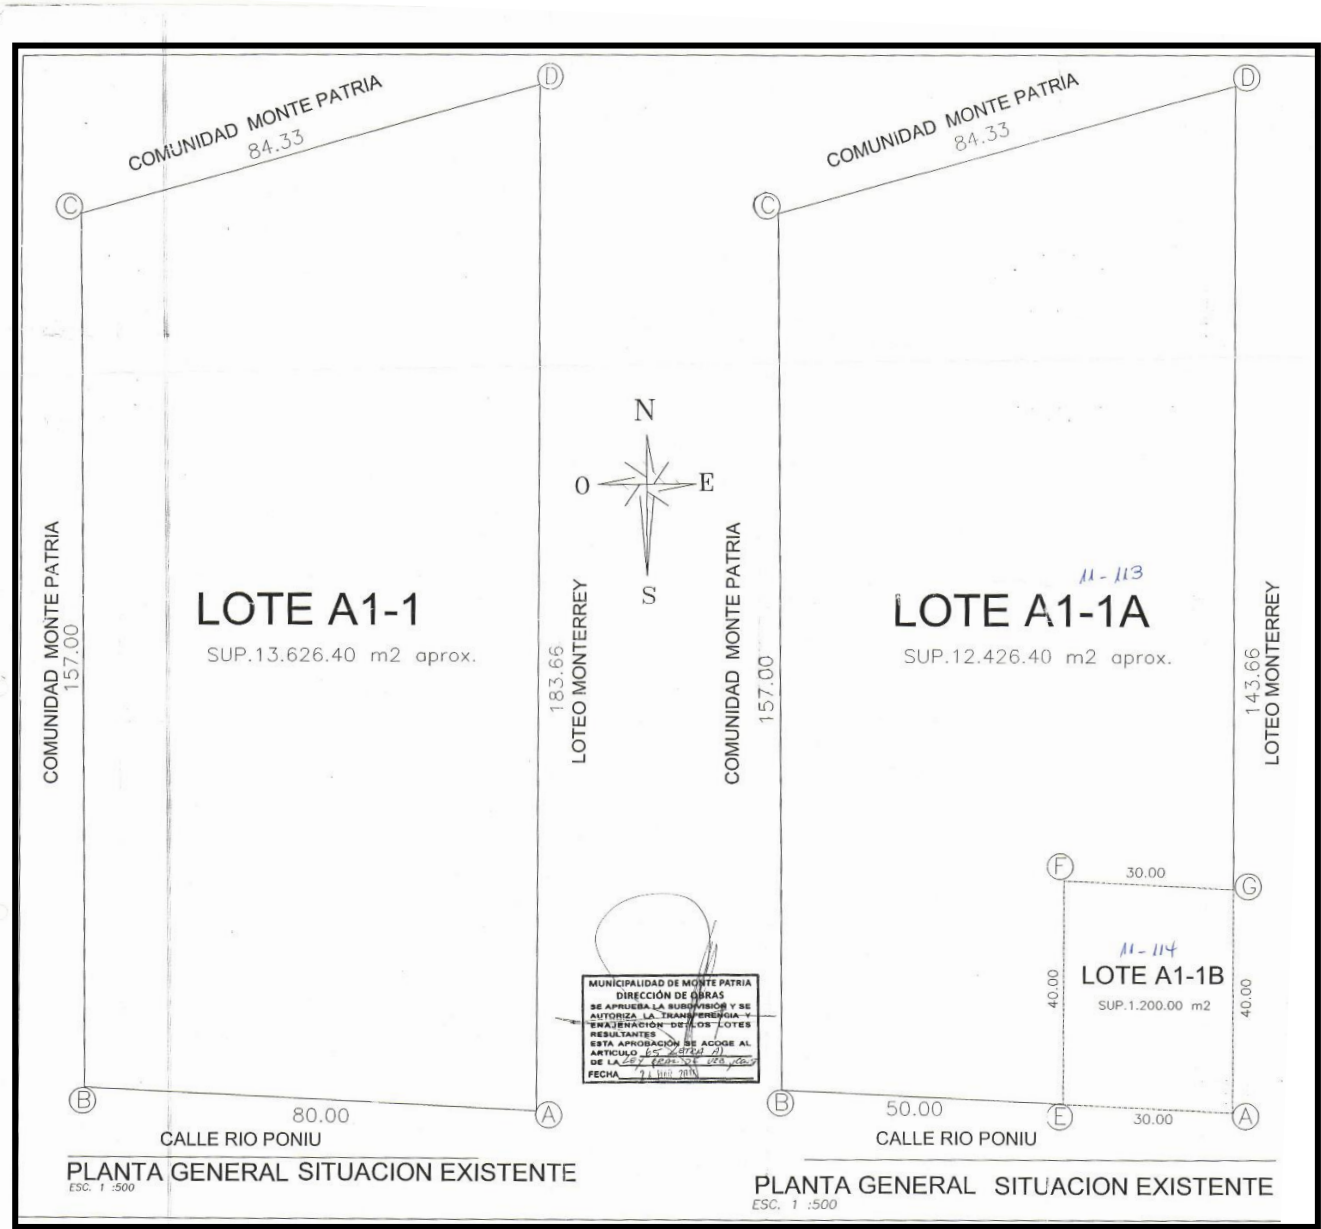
Subdivisión Lote A1 en Lotes A1-1A y A1-1B
